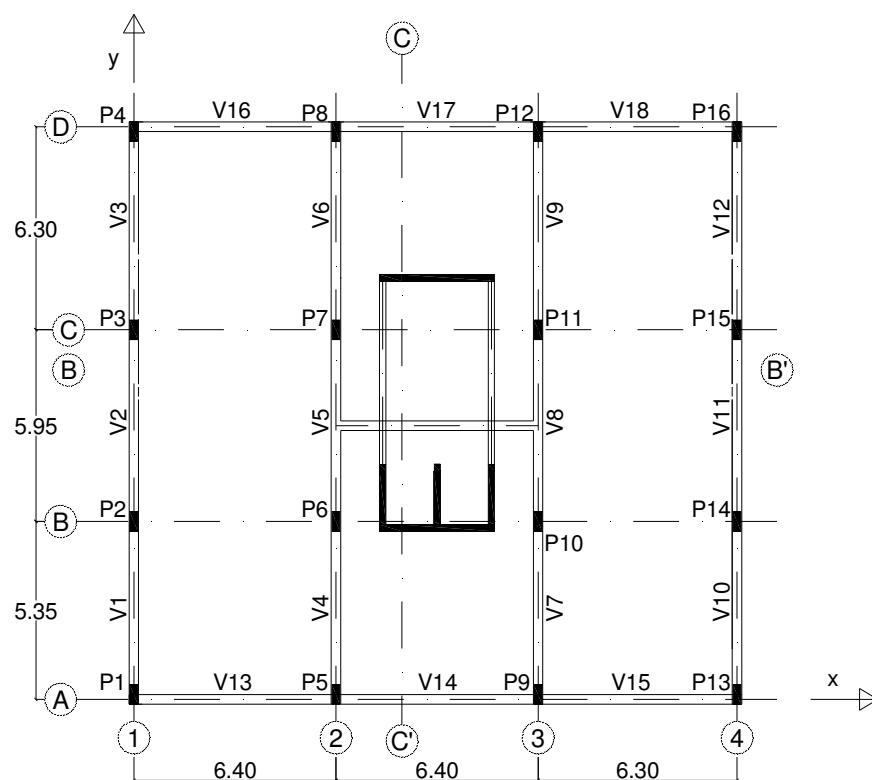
Planta estrutural de um piso superior com a numeração dos elementos
